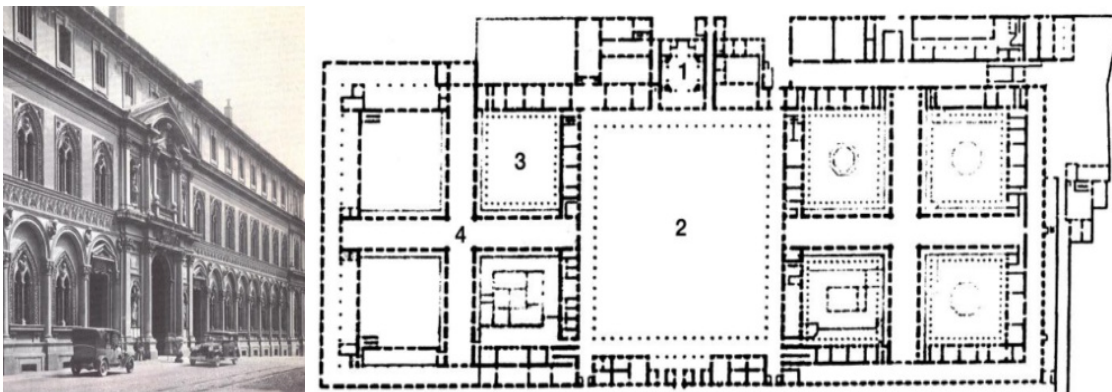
Fachada y planta del Hospital Mayor de Milán en Italia. Filarete (1456). Fuente [1]
